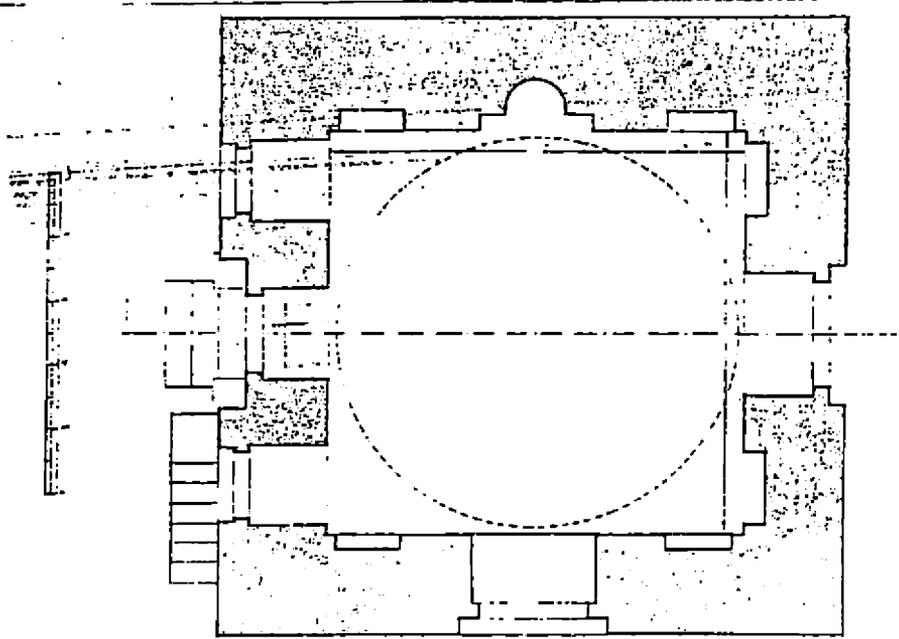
مسقط أفقي لقبة كل من الصوابي وسودون بقرافة السيوطي
